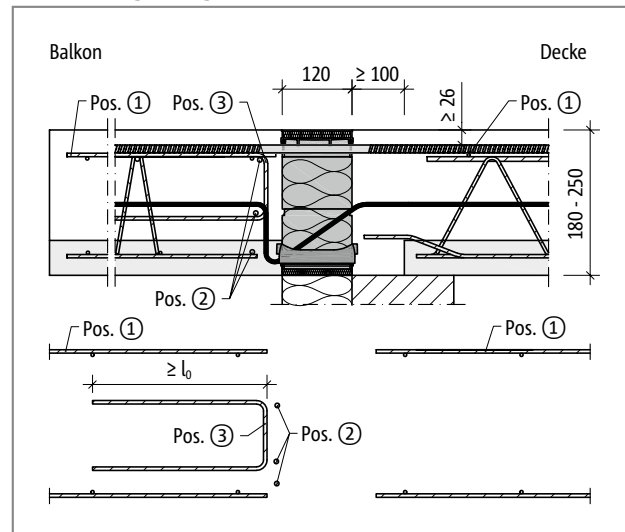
Schöck Isokorb® CXT Typ K-F: Bauseitige Bewehrung bei Balkonplattendicke h = 180 - 250 mm
